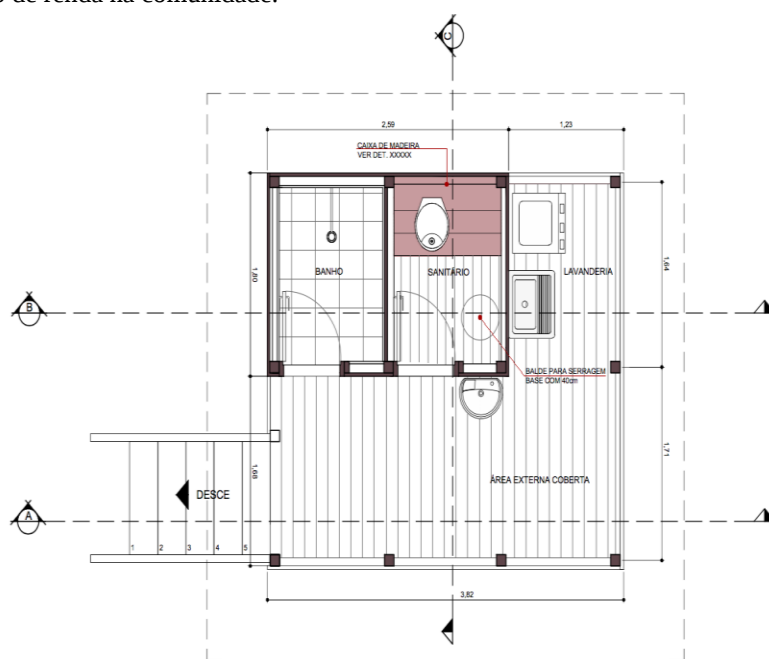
Planta Baixa - Módulo Sanitário com uso de vaso seco integrado à área de banho e lavanderia
